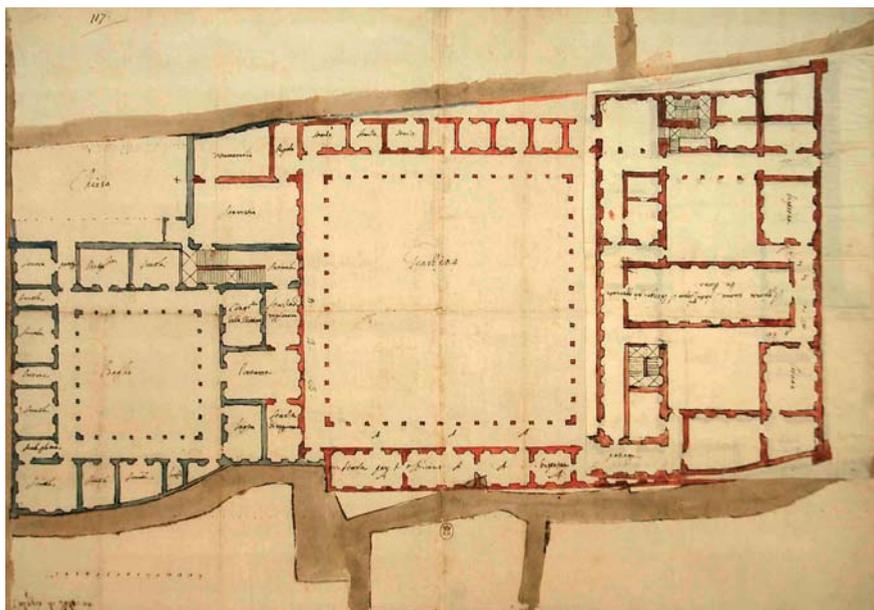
Palermo. Planimetria del Collegio Massimo (B.N.P., Hd-4d, 117; V. R. n. 228).
